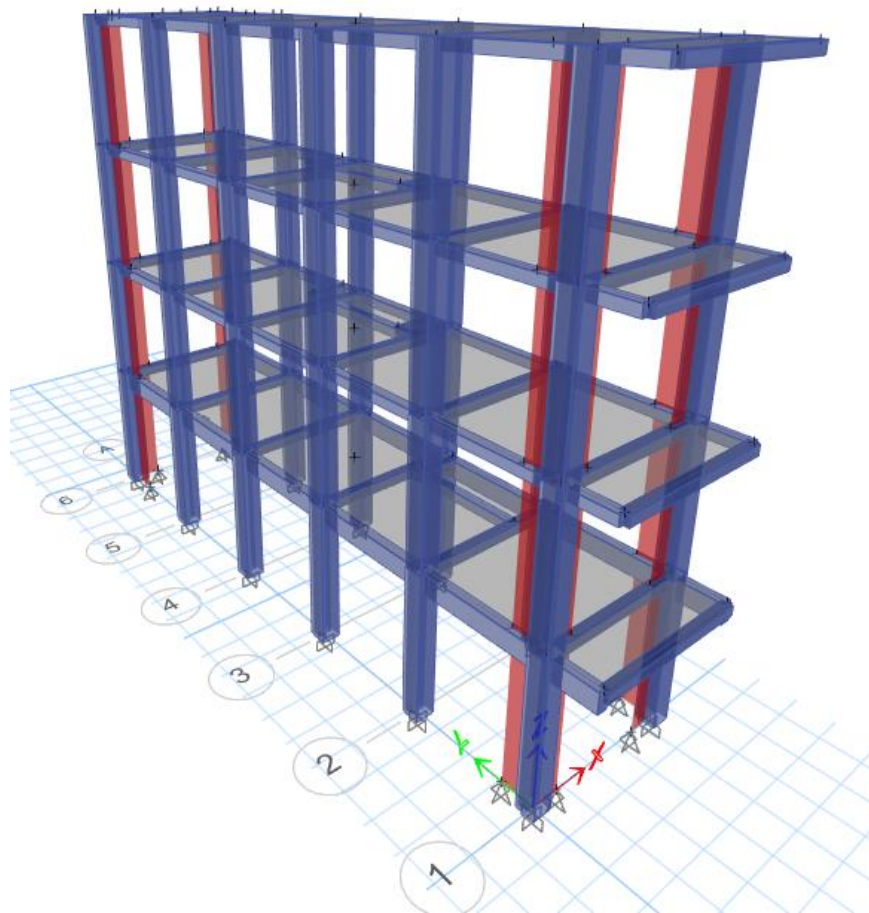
Modelado de la reestructuración del edificio “Ferretería Central”
